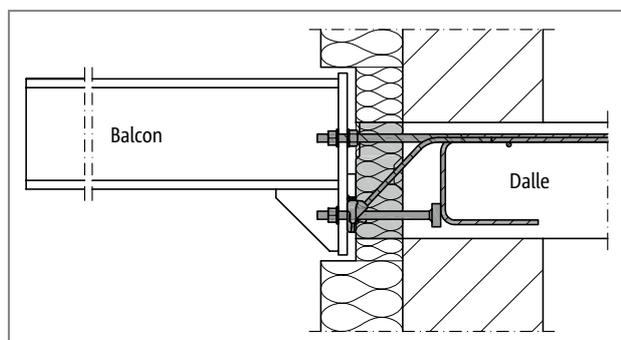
Schöck Isokorb® T type SK : Transition sans obstacle grâce au décalage en hauteur
